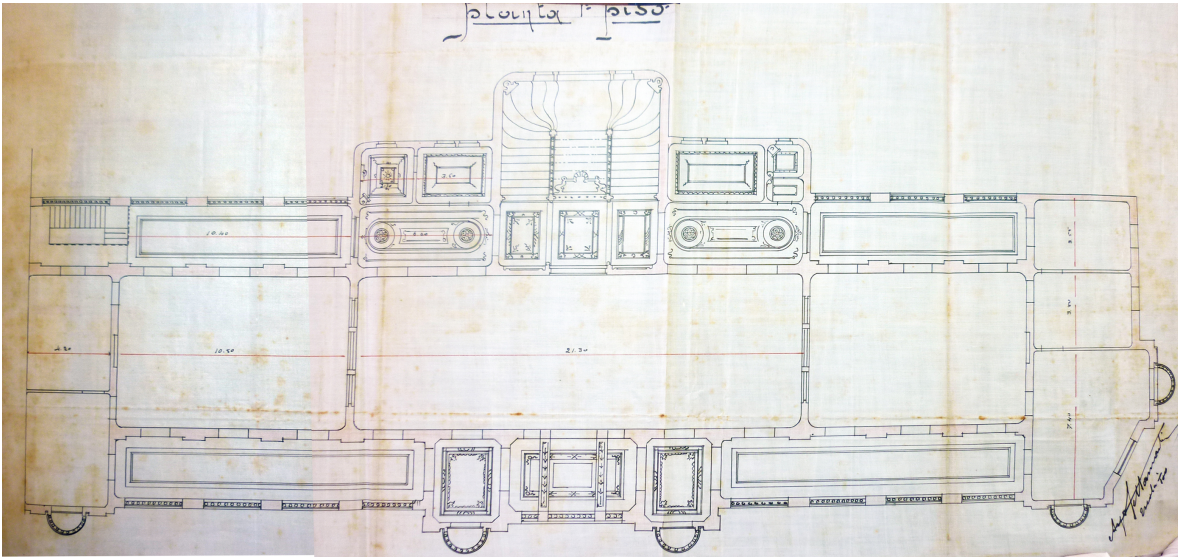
Planta primer piso, anteproyecto de la Casa de Gobierno (Domingo Tettamanti, SA DIP, 1907).
